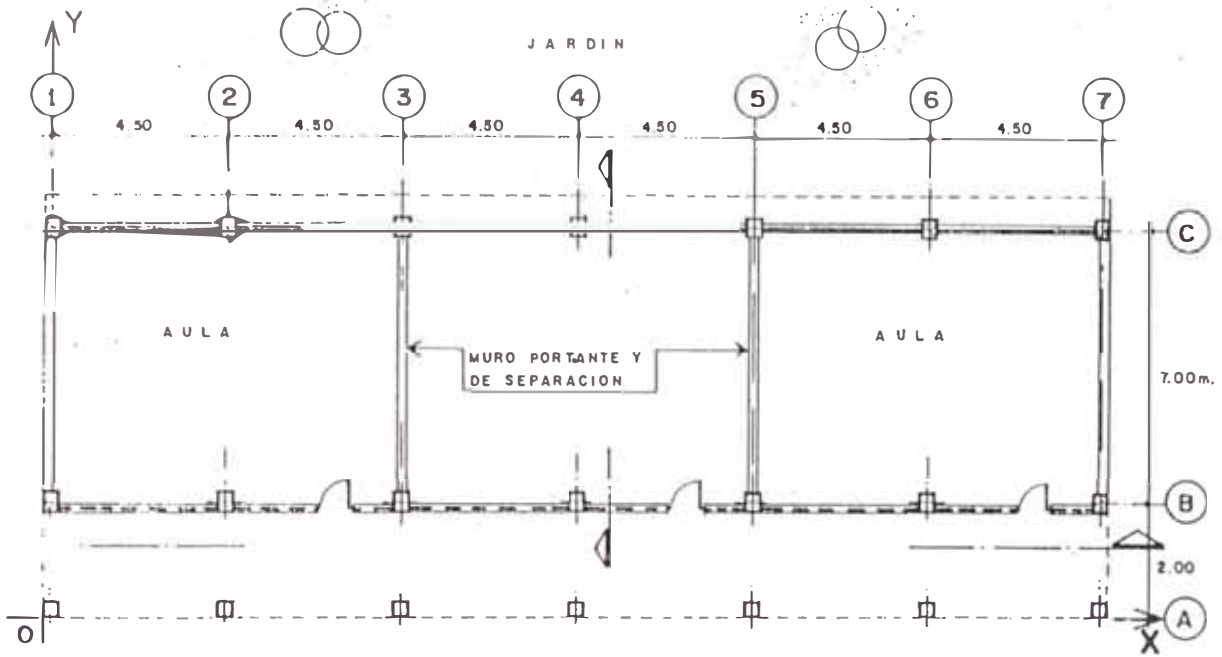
PLANTA TIPICA DE UN COLEGIO DAÑADO.
